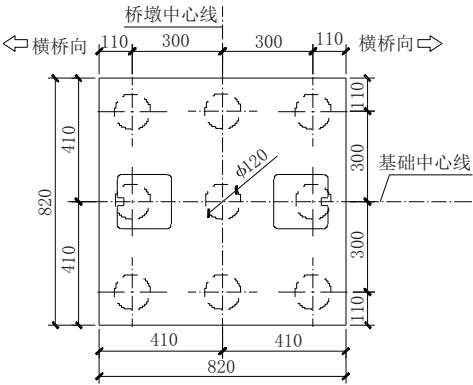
连续钢箱梁桥基础平面图 (单位: cm)
